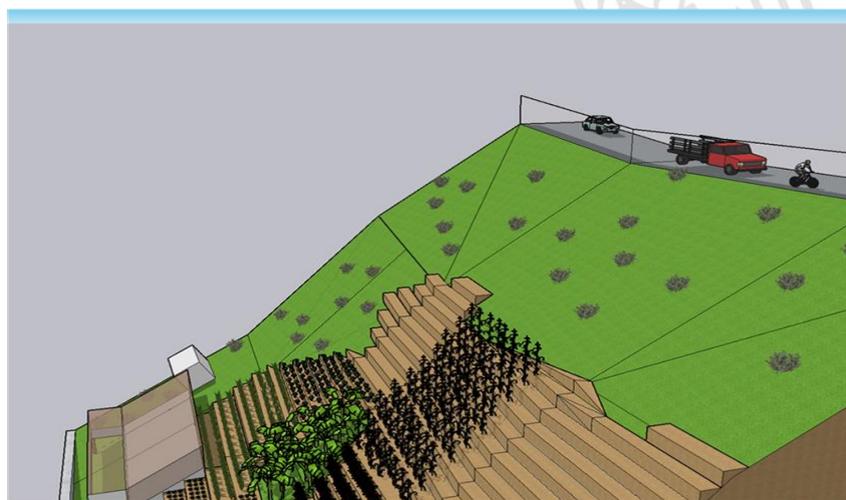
Distribución en planta actual. Vista Izquierda. Fuente: Sketchup
